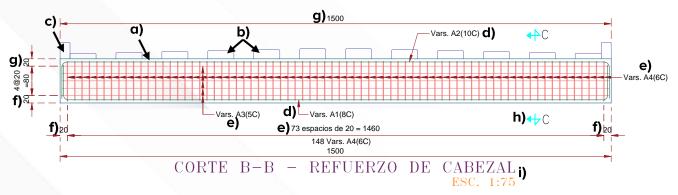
Ejemplo de elevación del refuerzo de cabezal de pila, corte B-B
